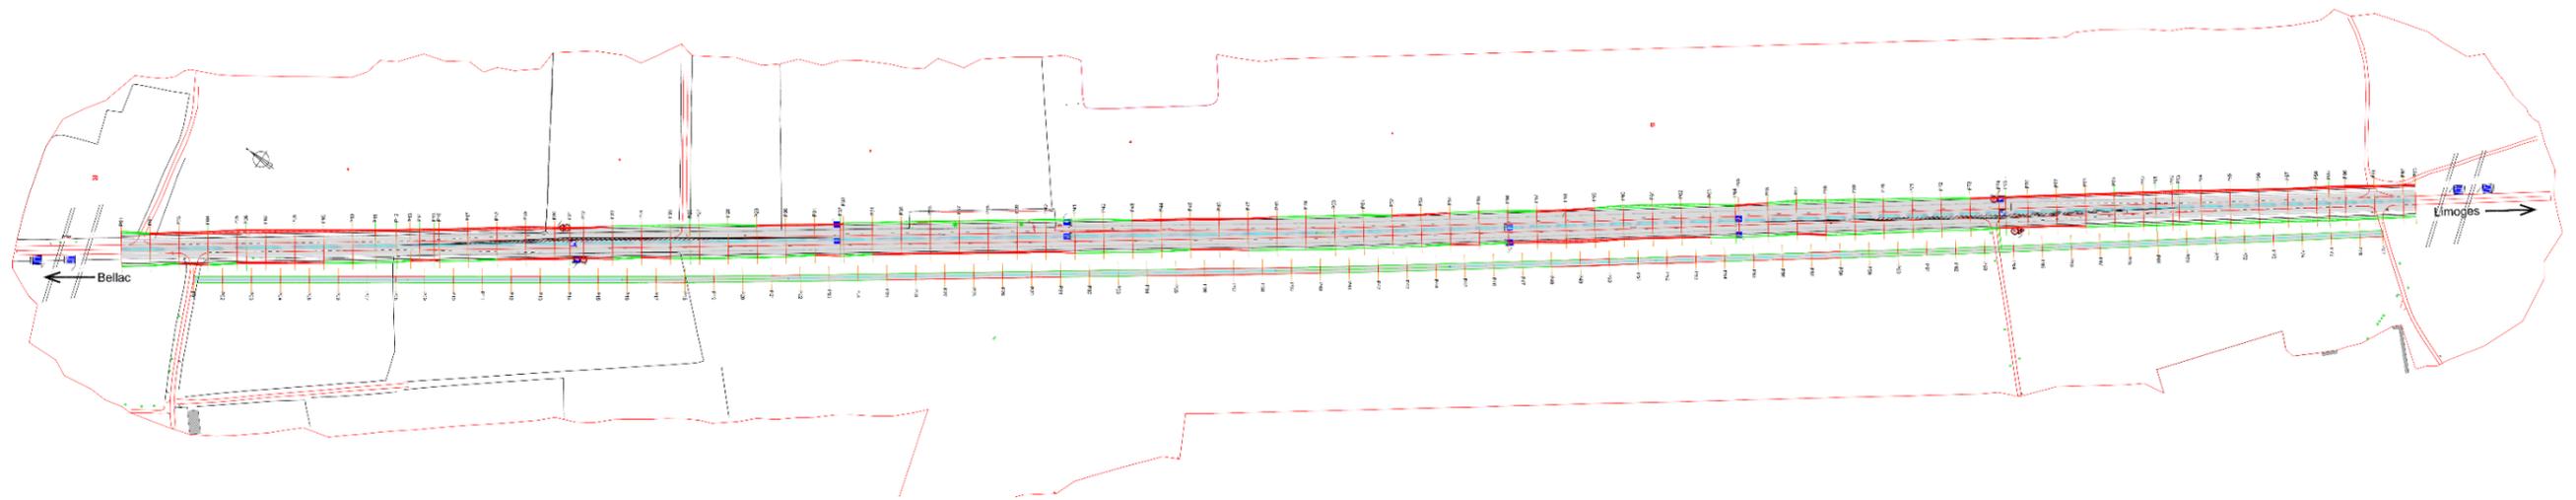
Section Berneuil créneau en place élargissement de part et d'autre, vue en plan
